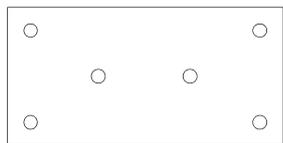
Plans de chevillage - panneaux de dimensions 1200 x 600 mm
